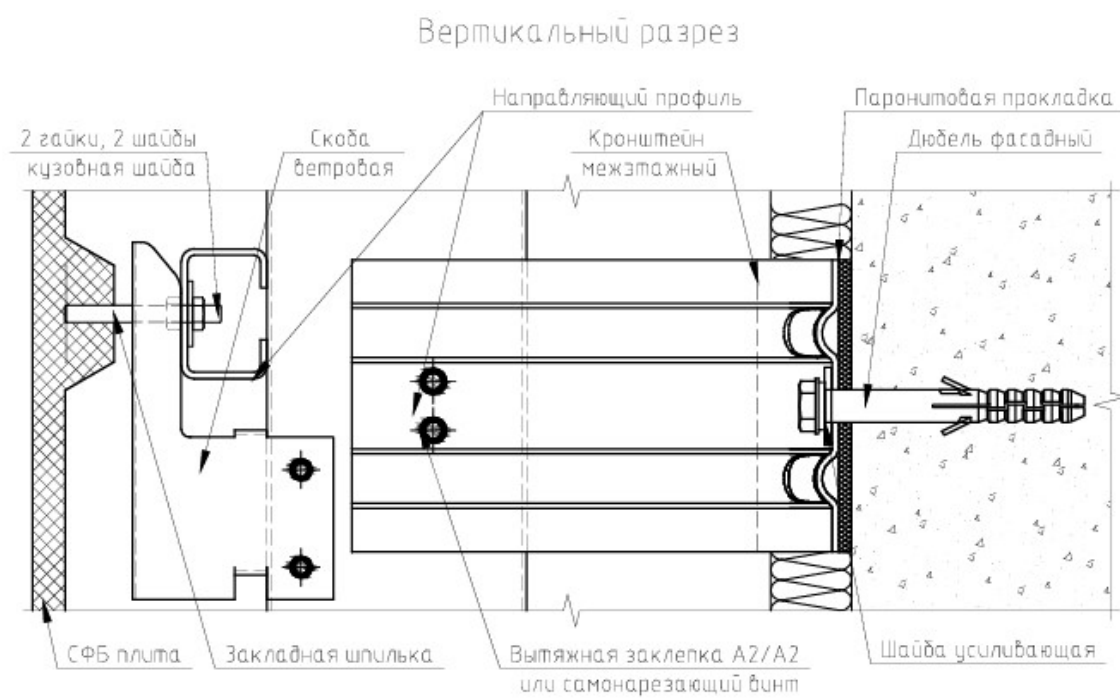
Крепление облицовки с помощью закладных деталей с резьбовой шпилькой к скобам НФС
